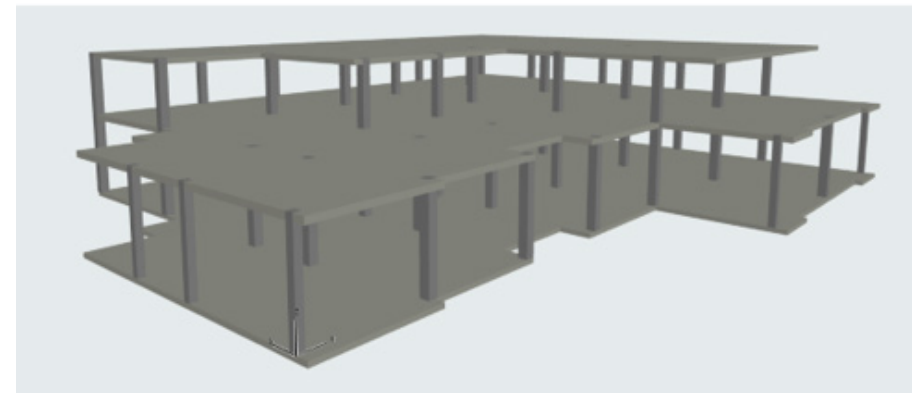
Vista 3D de columnas y forjados según plano arquitectónico. Elaboración: Del autor
